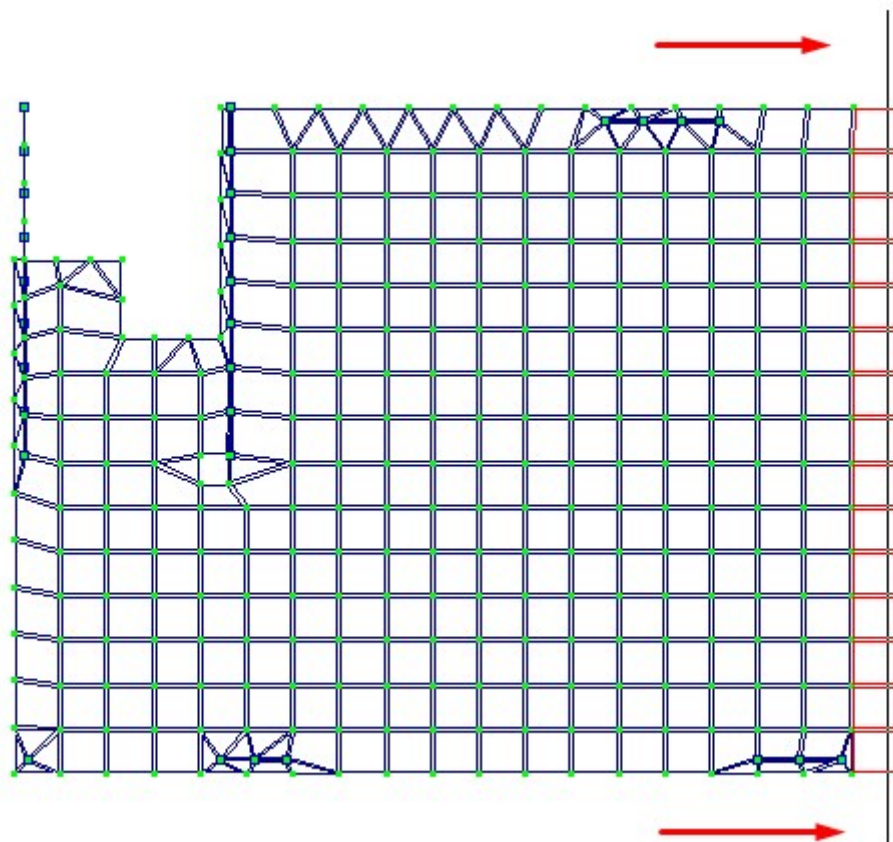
Переріз елементів плити 379-441 та напрямок погляду.
